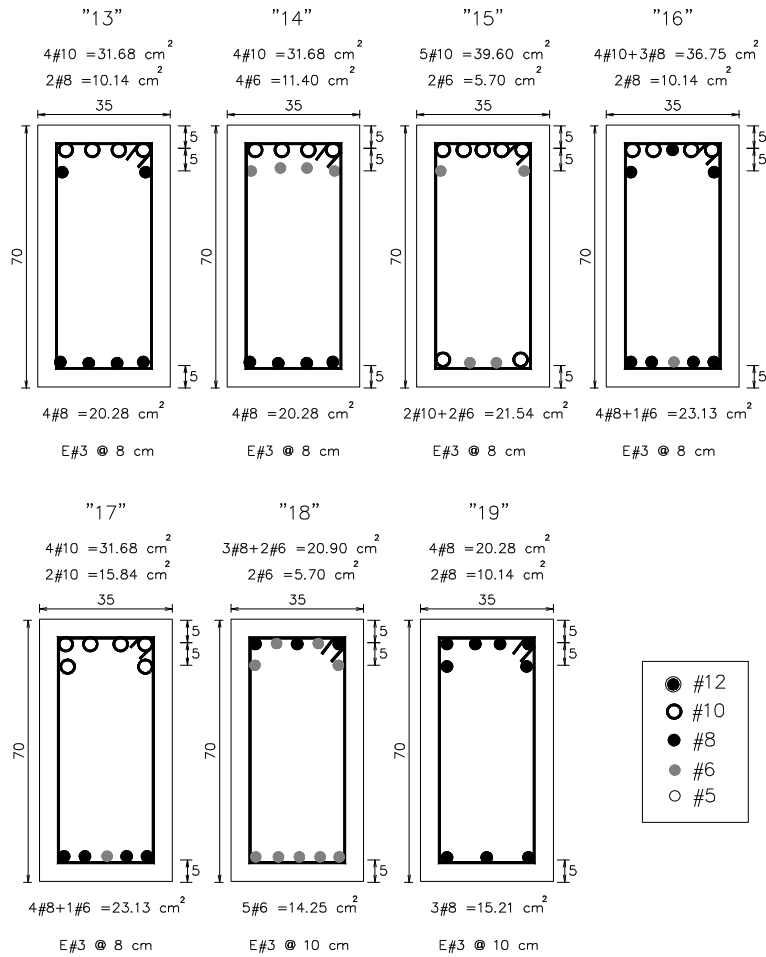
Tipos de armados propuestos para los extremos de las vigas del eje 2, estructuras de 17 niveles diseñadas en zona II (RDF-93 y RDF-04)
